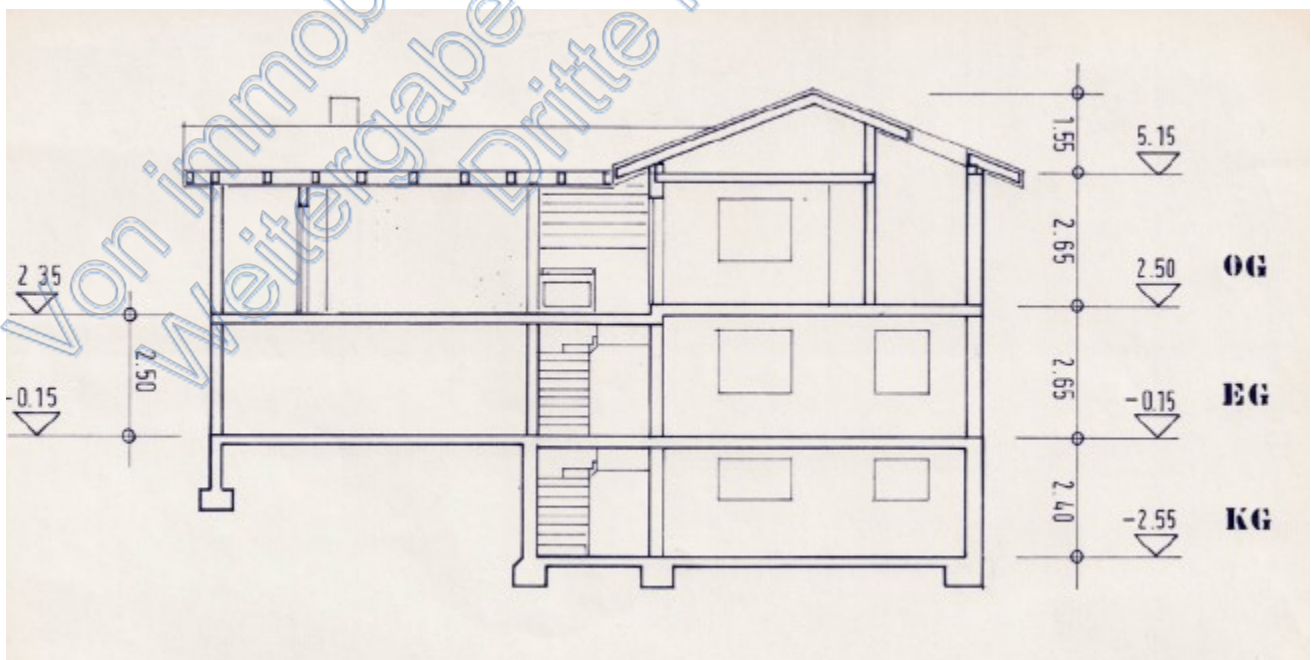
Gebäudeschnitt; hinterer Gebäudeteil (ohne Maßstab); Quelle: Objektunterlagen der Schuldnerin, Erweiterungsbau eines Zweifamilienhauses mit Garage
